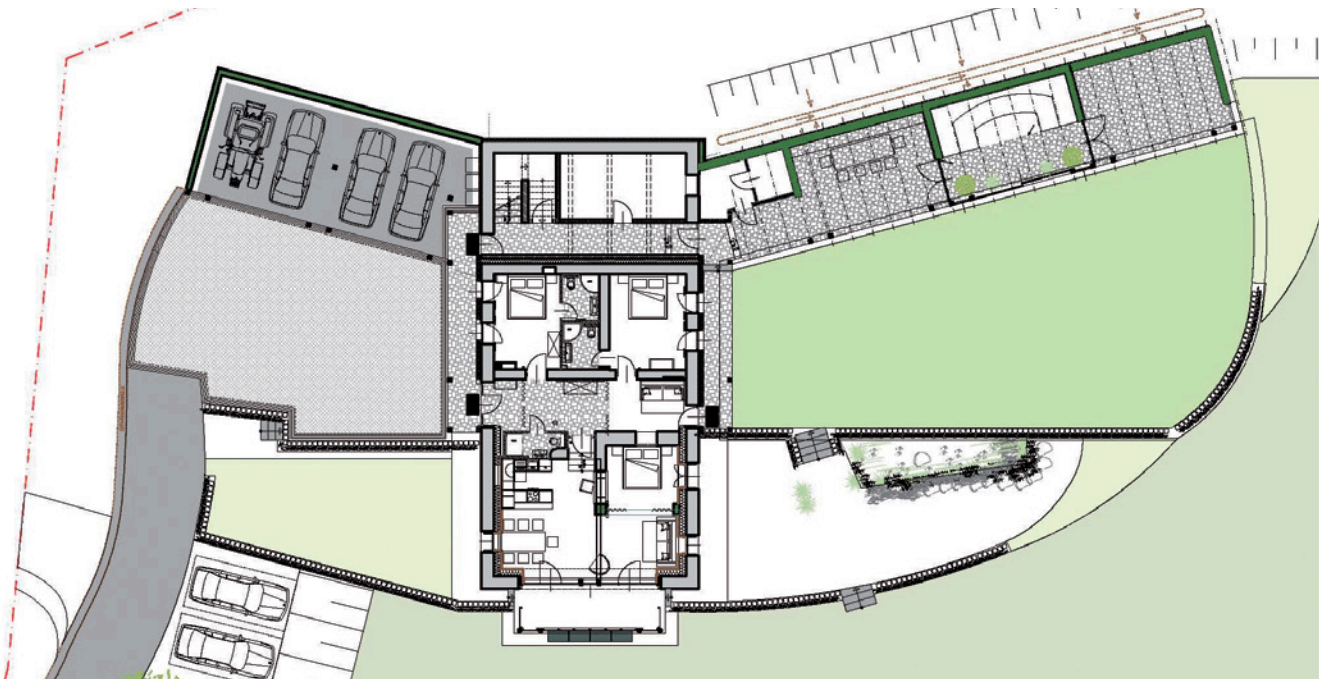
Gesamtgrundriss Erdgeschoss mit Glashaus
